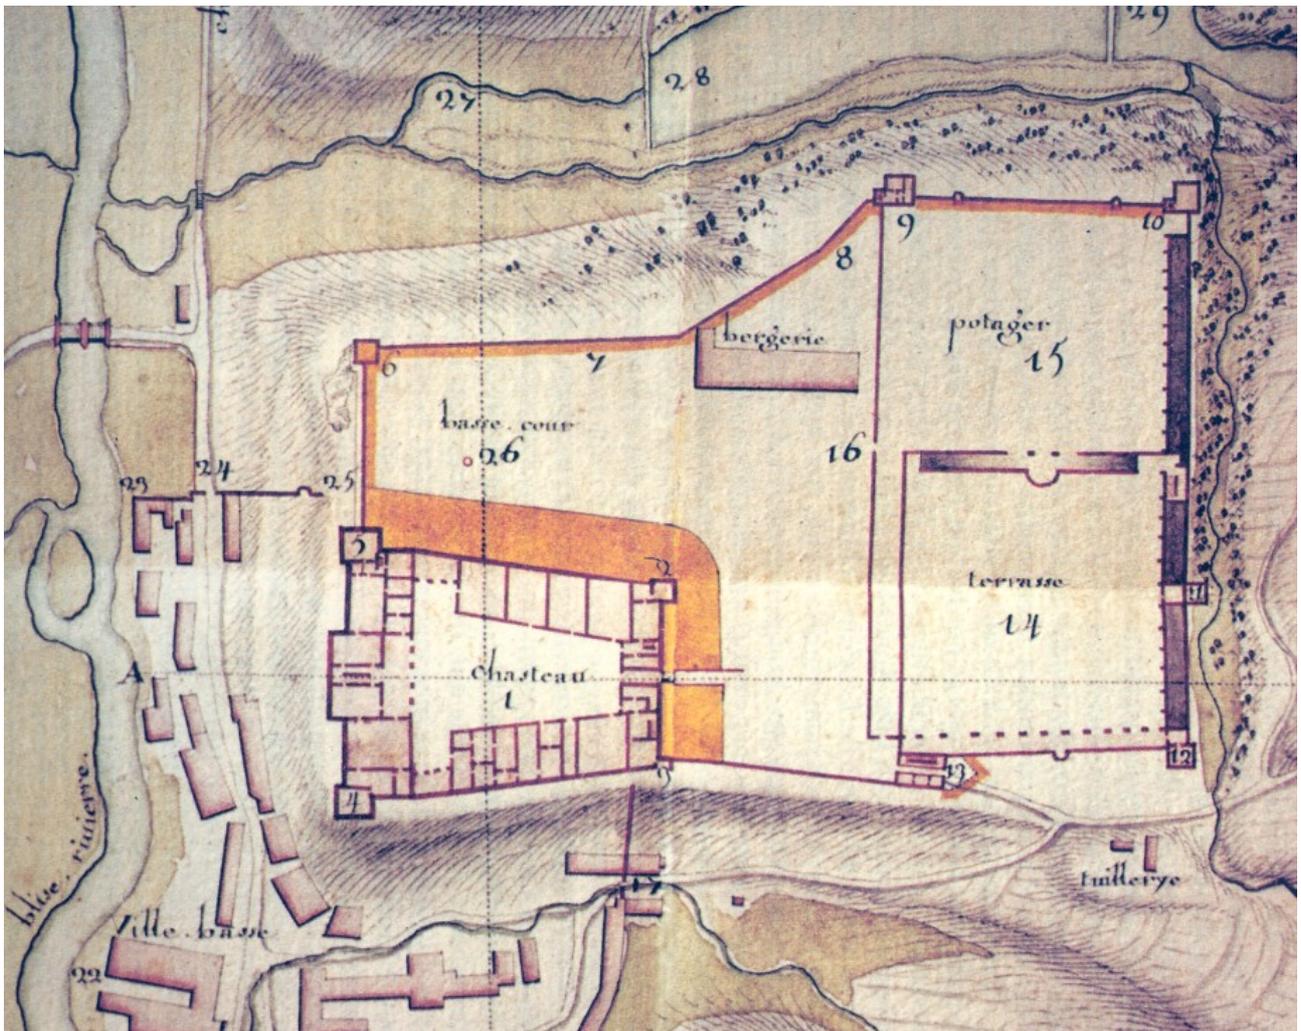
Grundrissplan des Schlosses Blieskastel mit Hof und Gartenanlagen, gesüdet. Im Bild unten verläuft die heutige Schlossbergstraße. (Detail aus dem Plan von Favart, 1704, Quelle: Saarländisches Landesarchiv)
